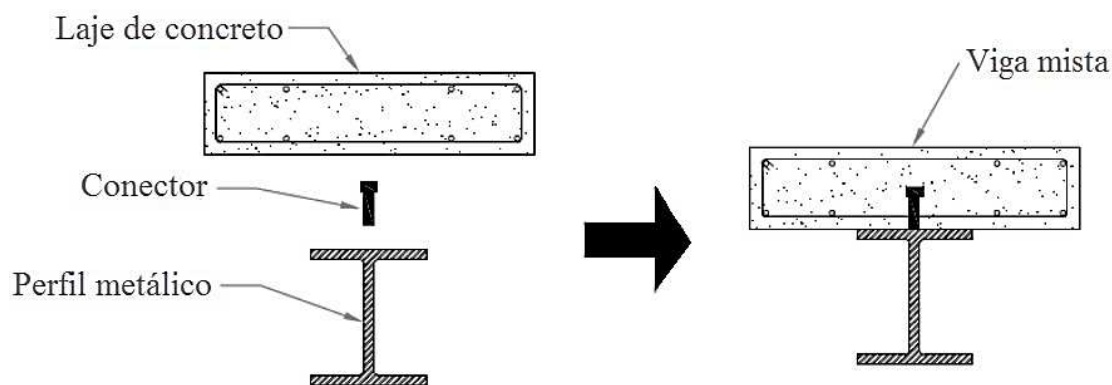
Viga mista convencional (Adaptado de ALVES, 2014).
